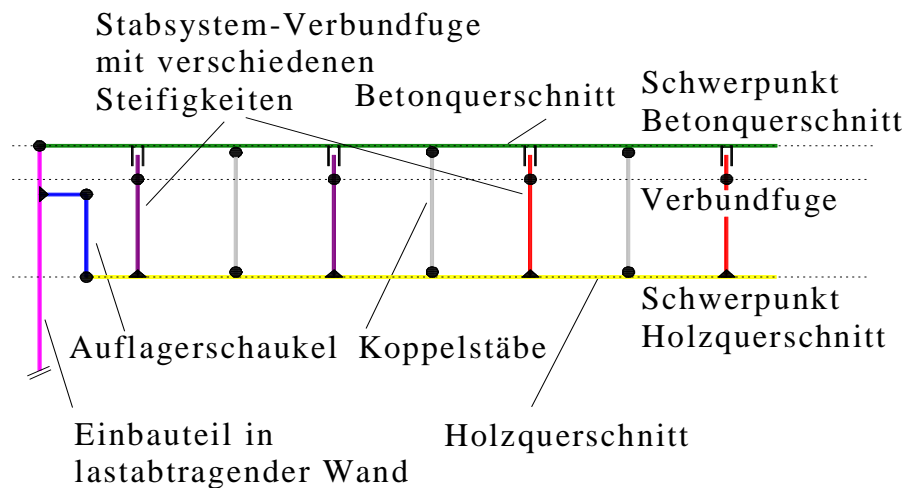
Statisches System am Endauflager: Holzverbundträger mit Auflagerschaukel und Einbauteil
